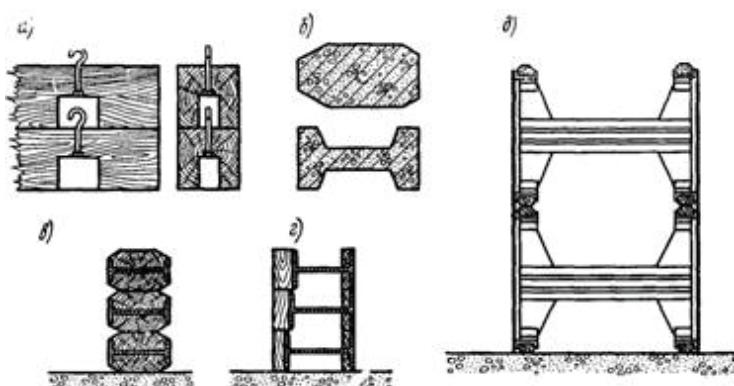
Типы шандор: а – деревянные брусья; б – железобетонные балки; в, г – балочного типа из прокатных двутавровых балок; д – из двутавровых балок составного сечения
